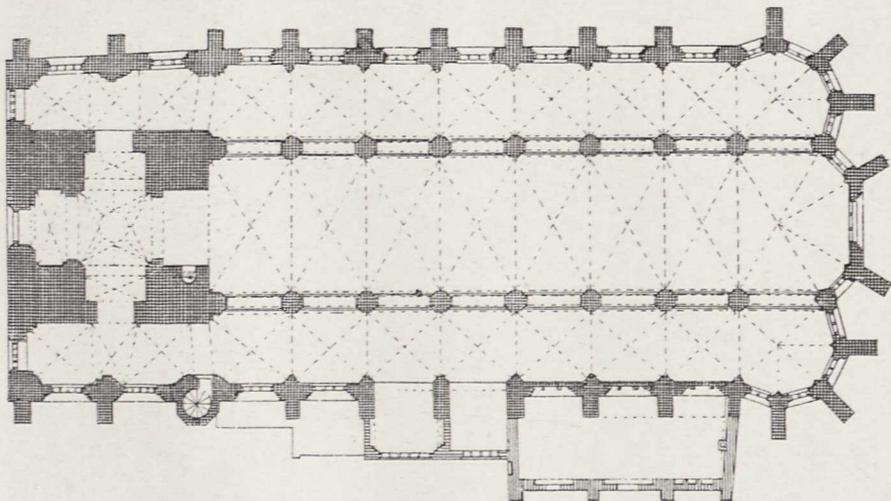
Anklam; Nicolaikirche, Grundriss. 1:500.
